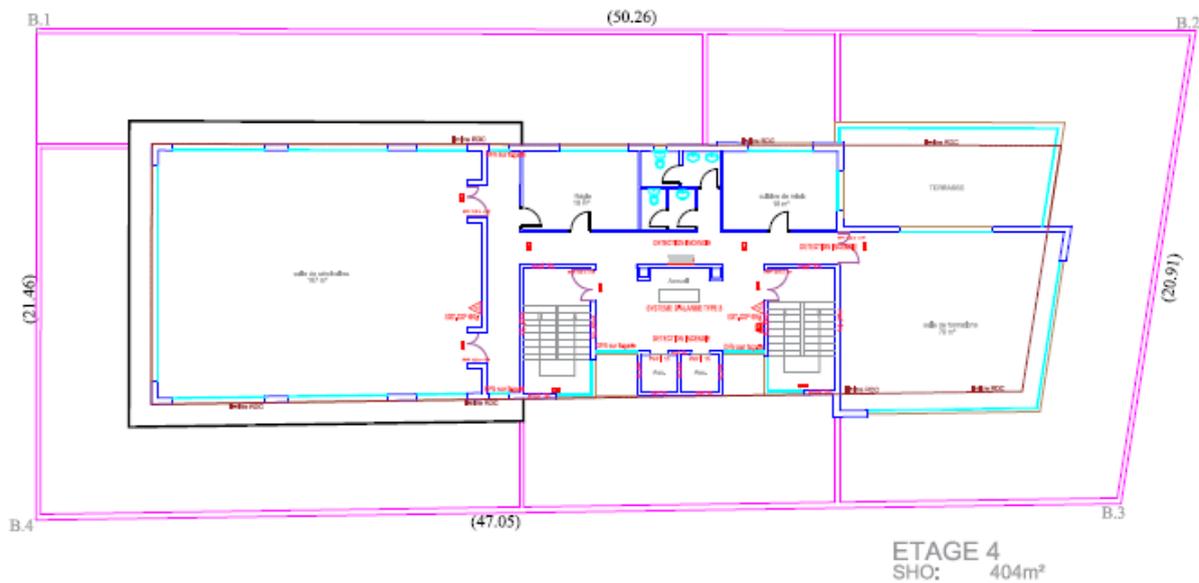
Plan masse du 4^{ème} étage du centre Multiservices
